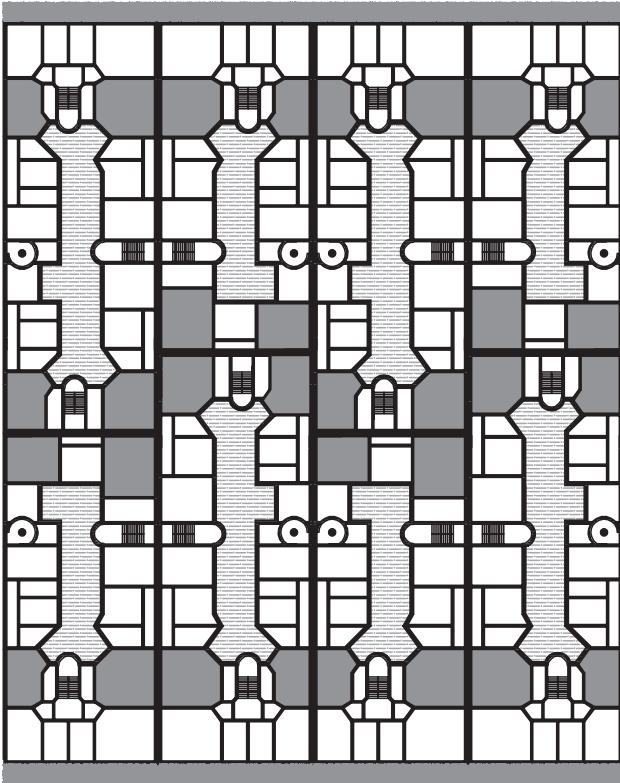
Grundriss: Berliner Zimmer im Berliner Block
